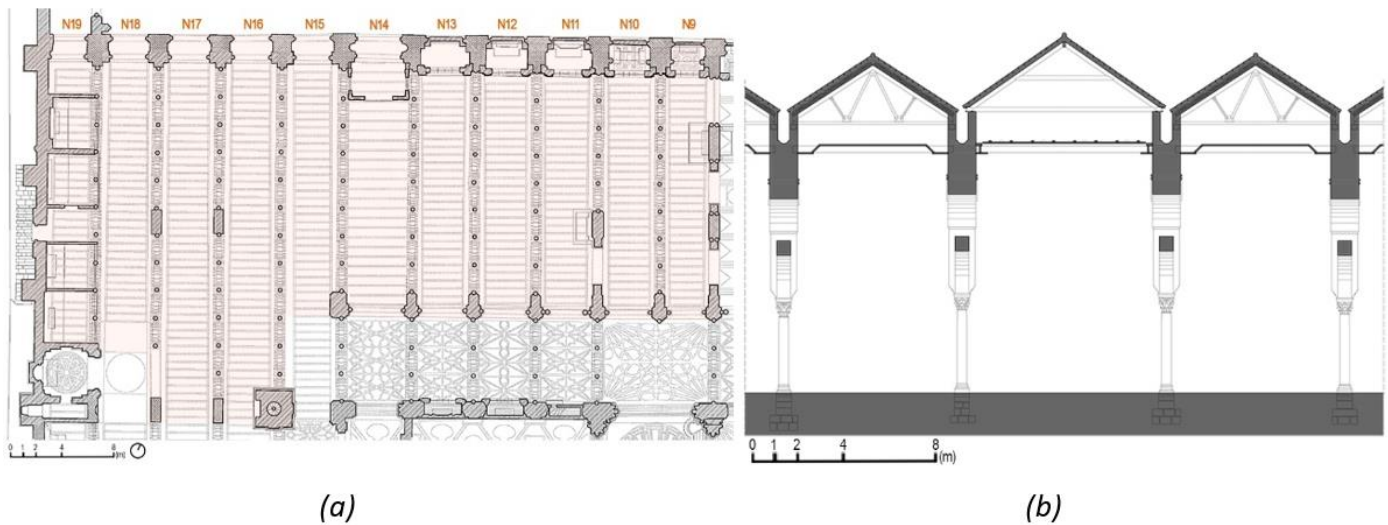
(a) Planta del sector de Abd 'al-Rahman I, indicando el número de nave (N). (b) Detalle constructivo de la solución de cubierta: con cerchas de madera originales y metálicas del siglo XX.
